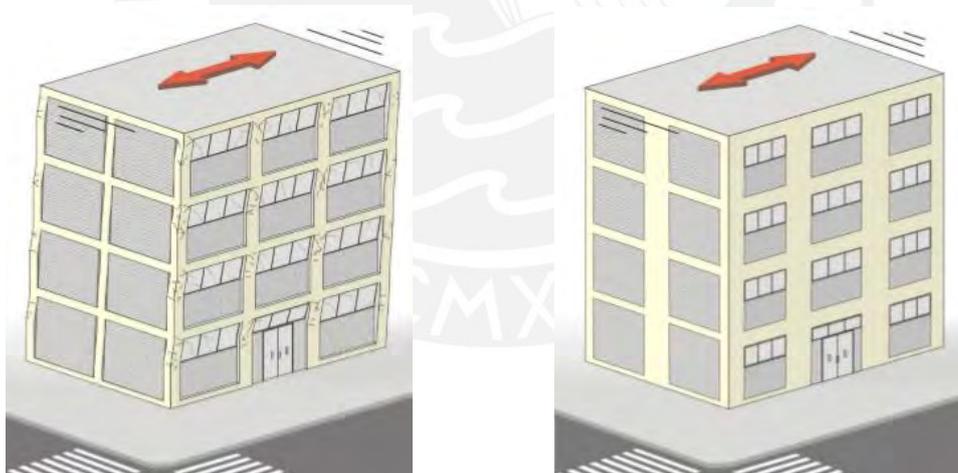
Edificio con columnas cortas (lado izquierdo) y edificios con columnas rígidas (lado derecho)
